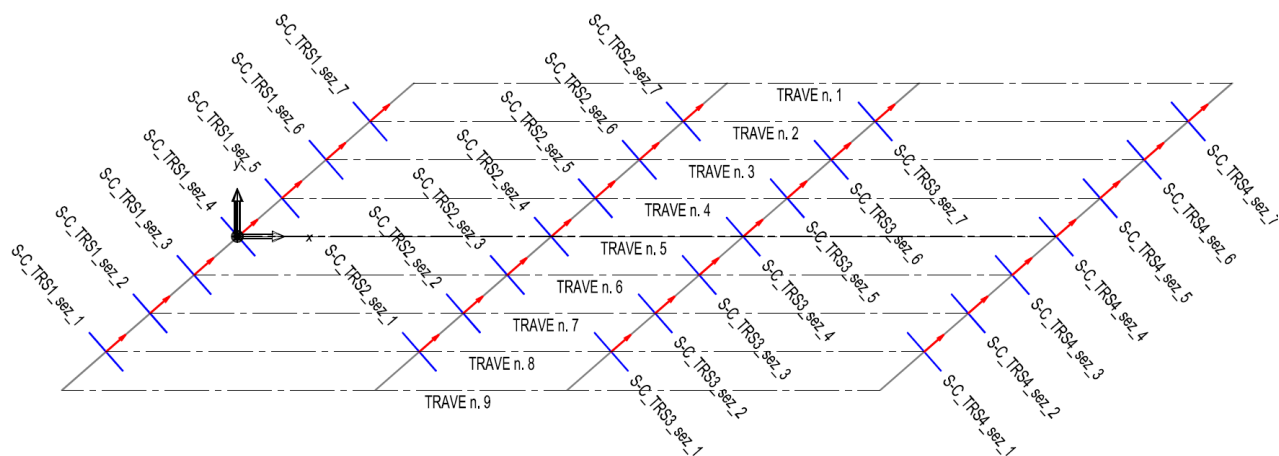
Posizione Section Cuts sui trasversi – Vista in Pianta
